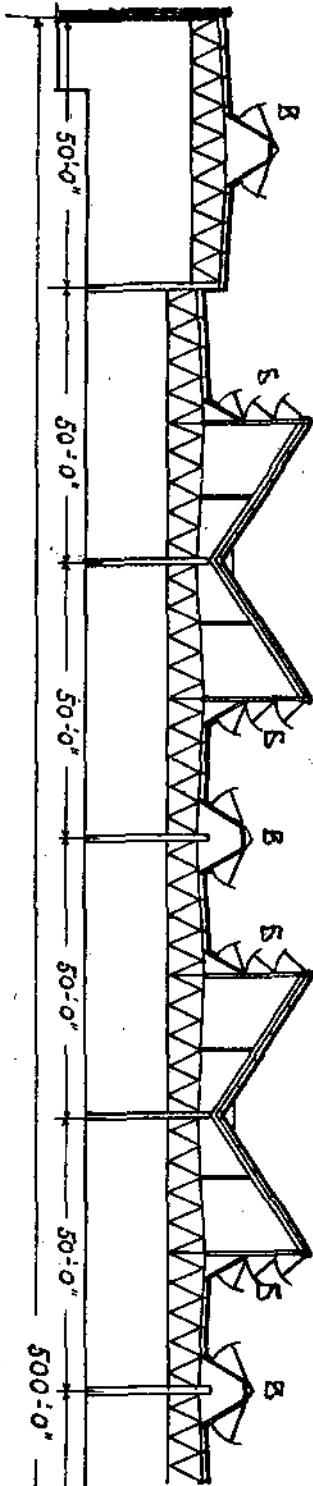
Естественная вентиляция при помощи перекрытия Понд при небольшом пролете.
